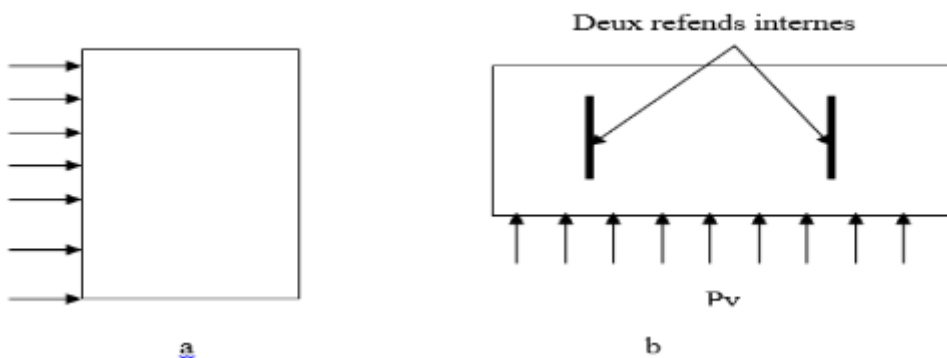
a- coupe longitudinale d'un bâtiment soumis au vent. b- coupe transversale
